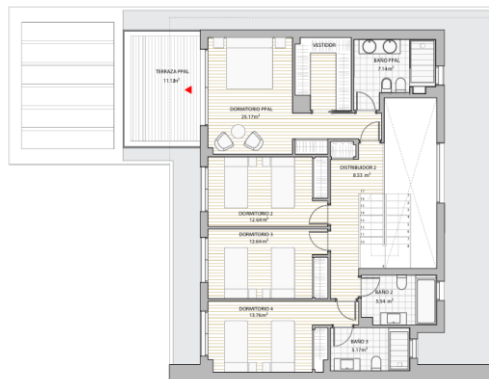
Plano de la planta superior de la vivienda (Fuente: Levitt - Constructora)
